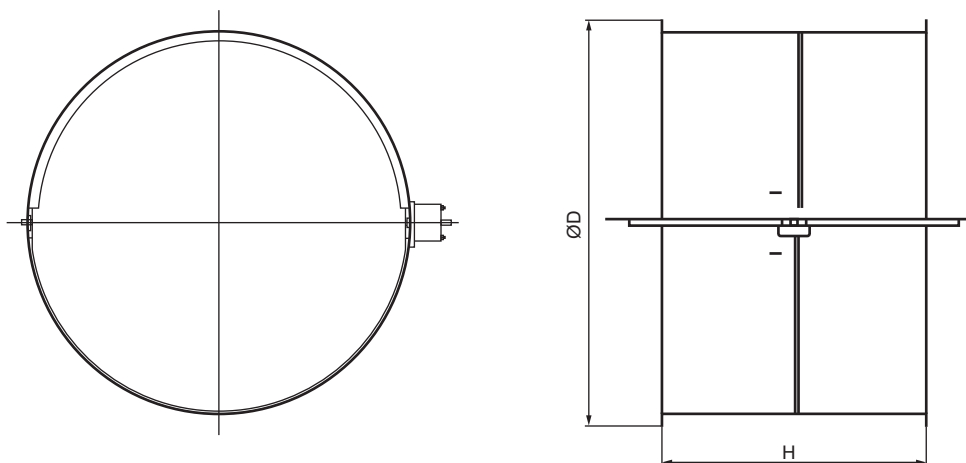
Габаритные и присоединительные размеры клапанов типа КВМ-П круглого сечения с ниппельным соединением.
